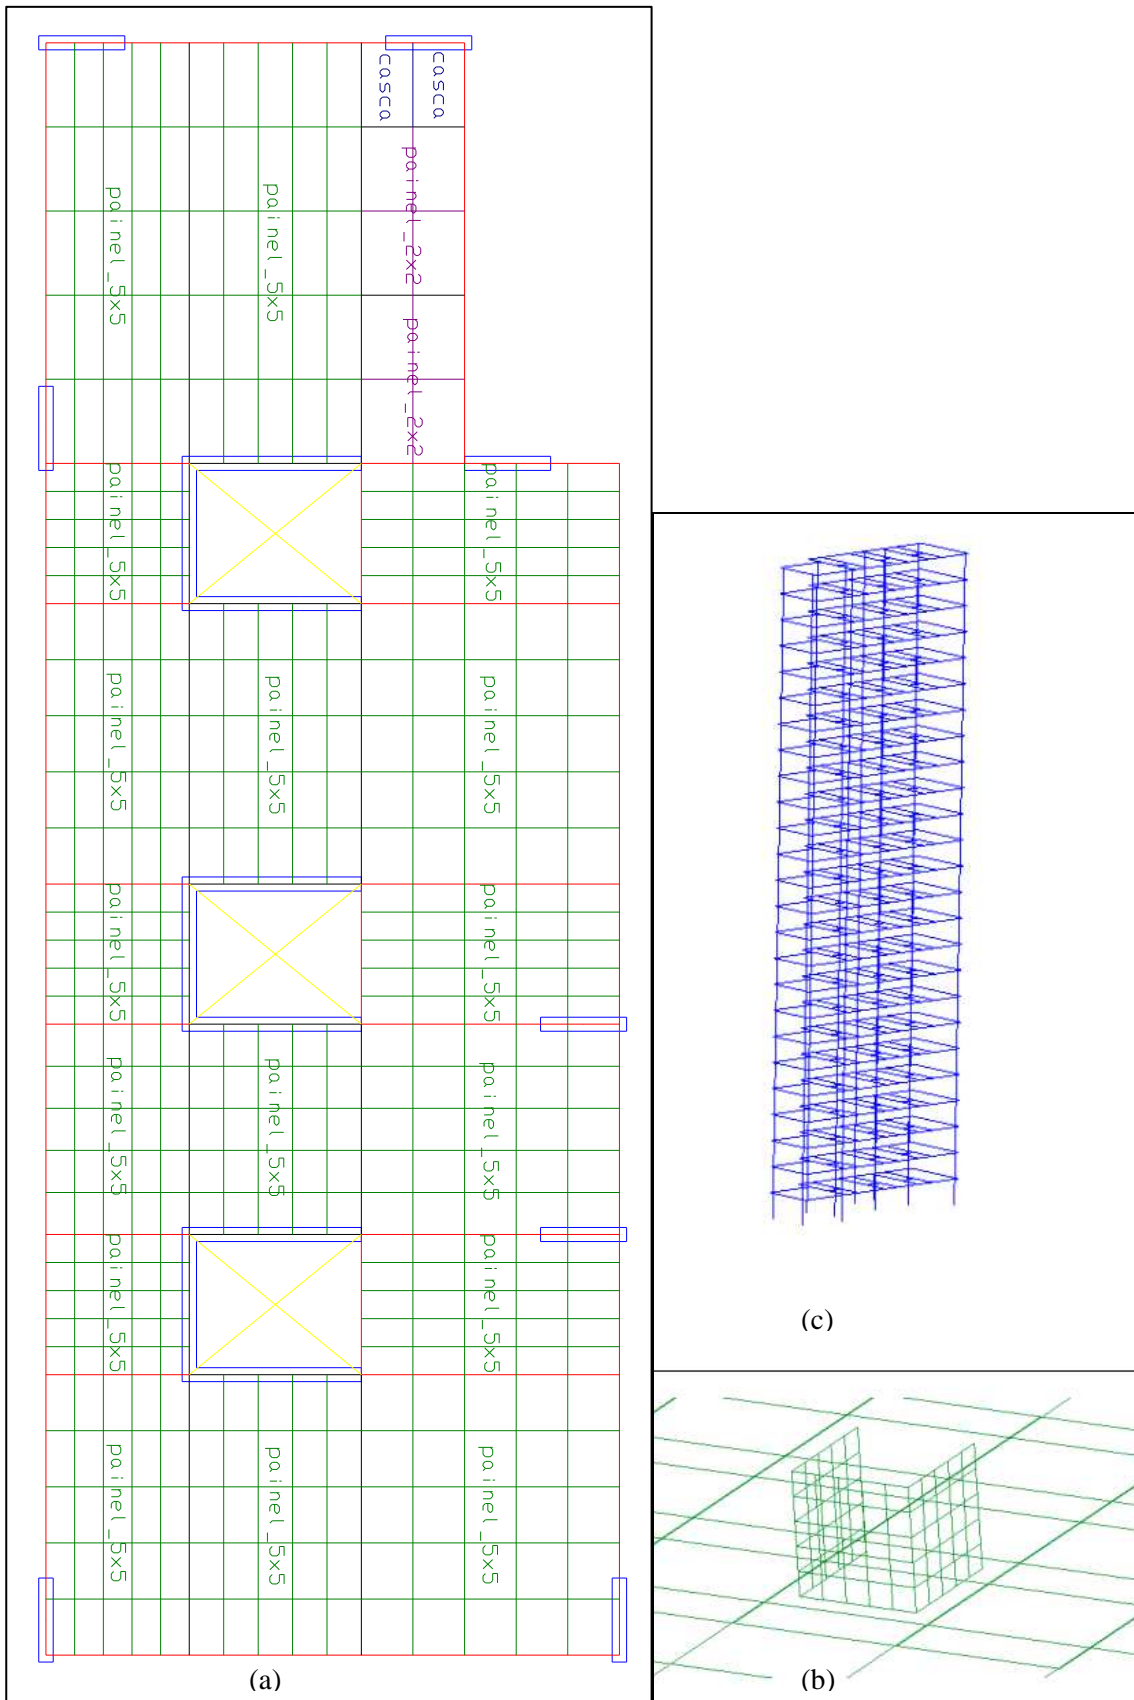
malha de elementos finitos do pavimento tipo – exemplo 3: (a) malha do pavimento; (b) detalhe do núcleo; (c) estrutura discretizada
